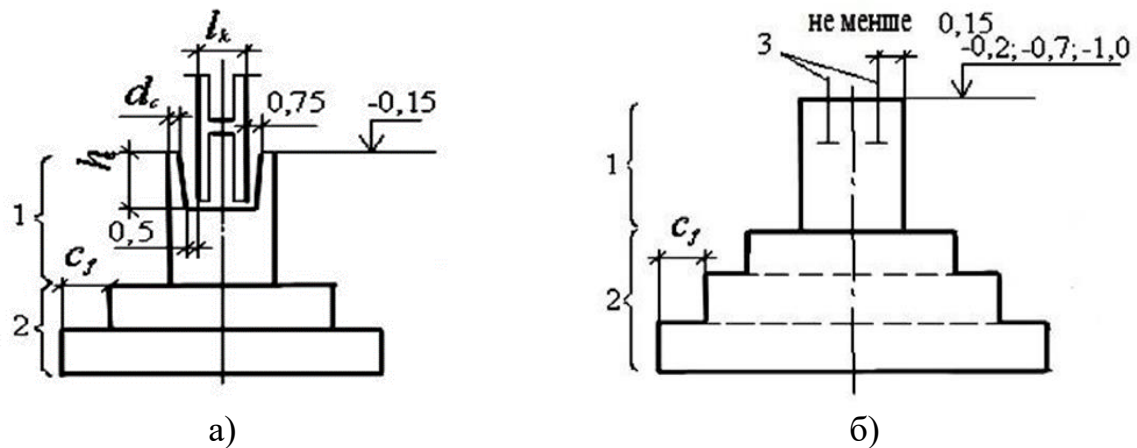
Ступінчасті фундаменти: а – під збірну колону; б – під металеву колону; 1 – підколонник; 2 – плитна частина; 3 – анкерні болти
